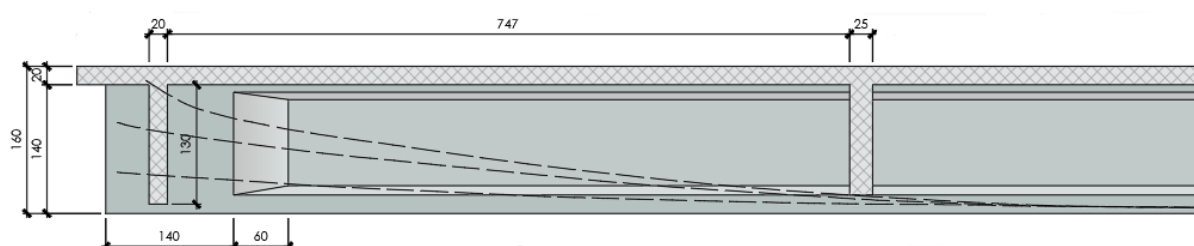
Trave impalcato c.a.p – Disposizione dei cavi
